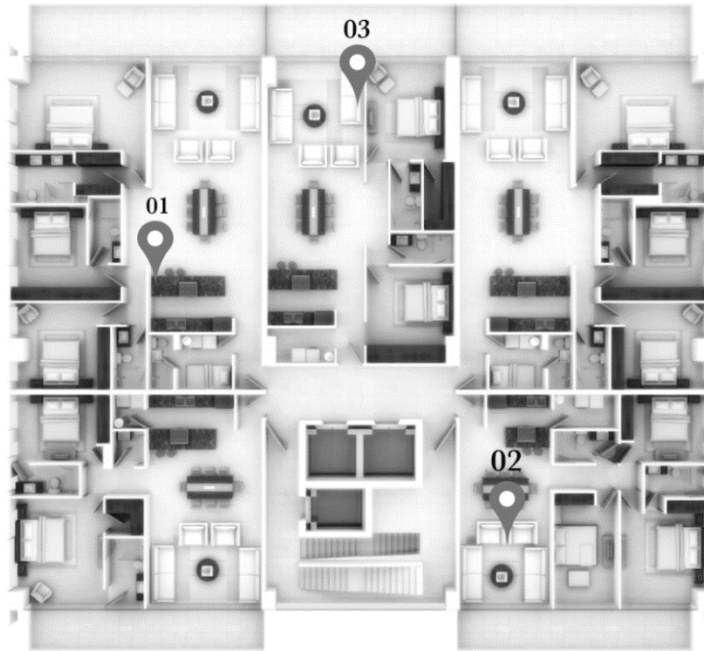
Planta arquitectónica tipo departamentos Central Park
